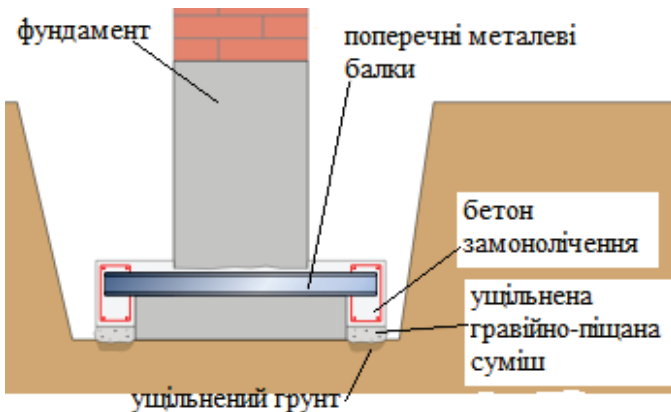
Встановлення розвантажувальних балок фундаментів
